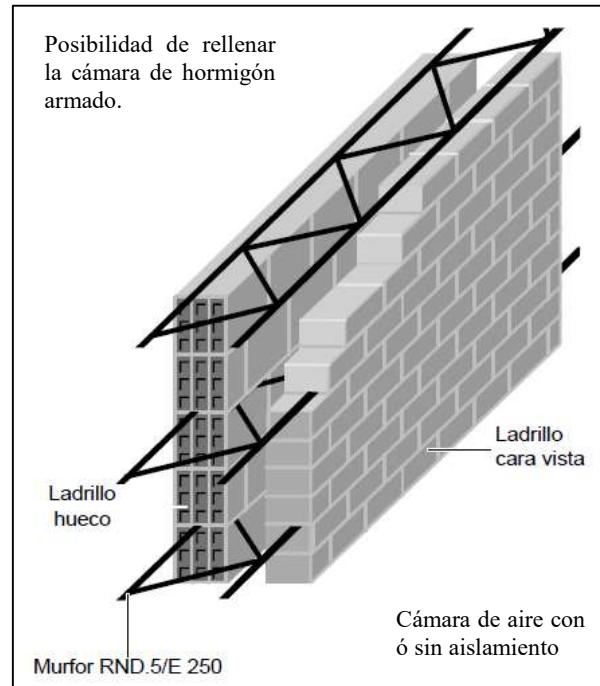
Muro Capuchino con las dos hojas atadas con armadura de celosía en los tendeles.
